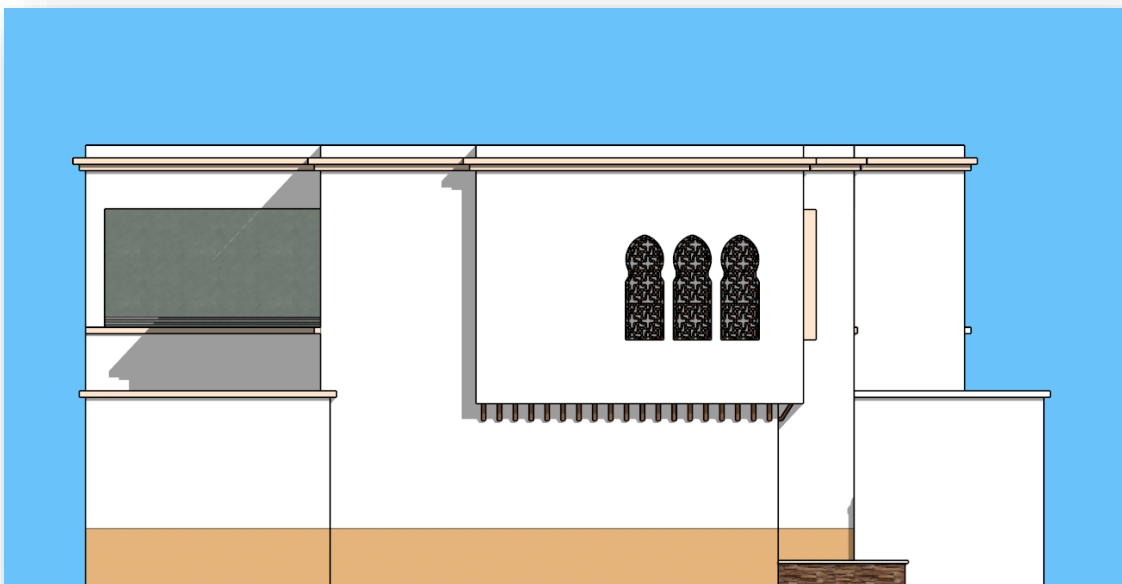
FAÇADE LATÉRALE (OUEST) REALISE PAR SKETCHUP
